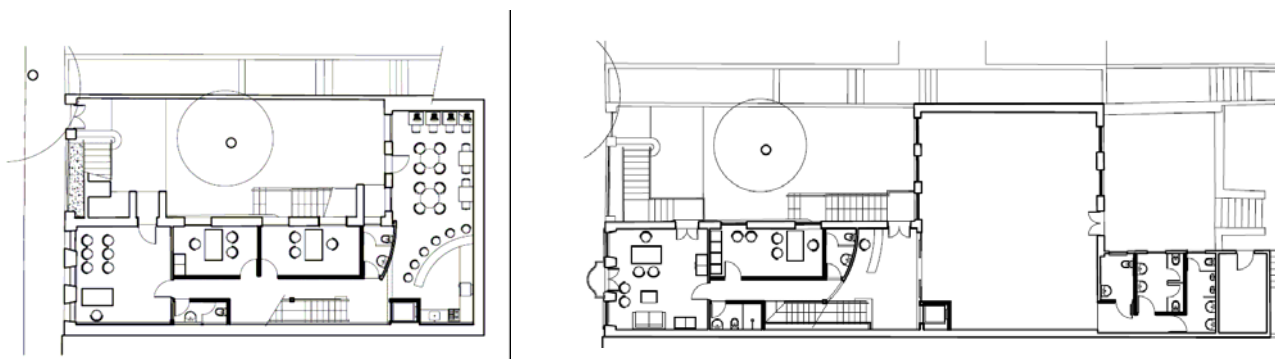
Planta Baixa Pav. Térreo (e) e Planta Baixa Pav. Superior (d) do projeto de intervenção, 2004
